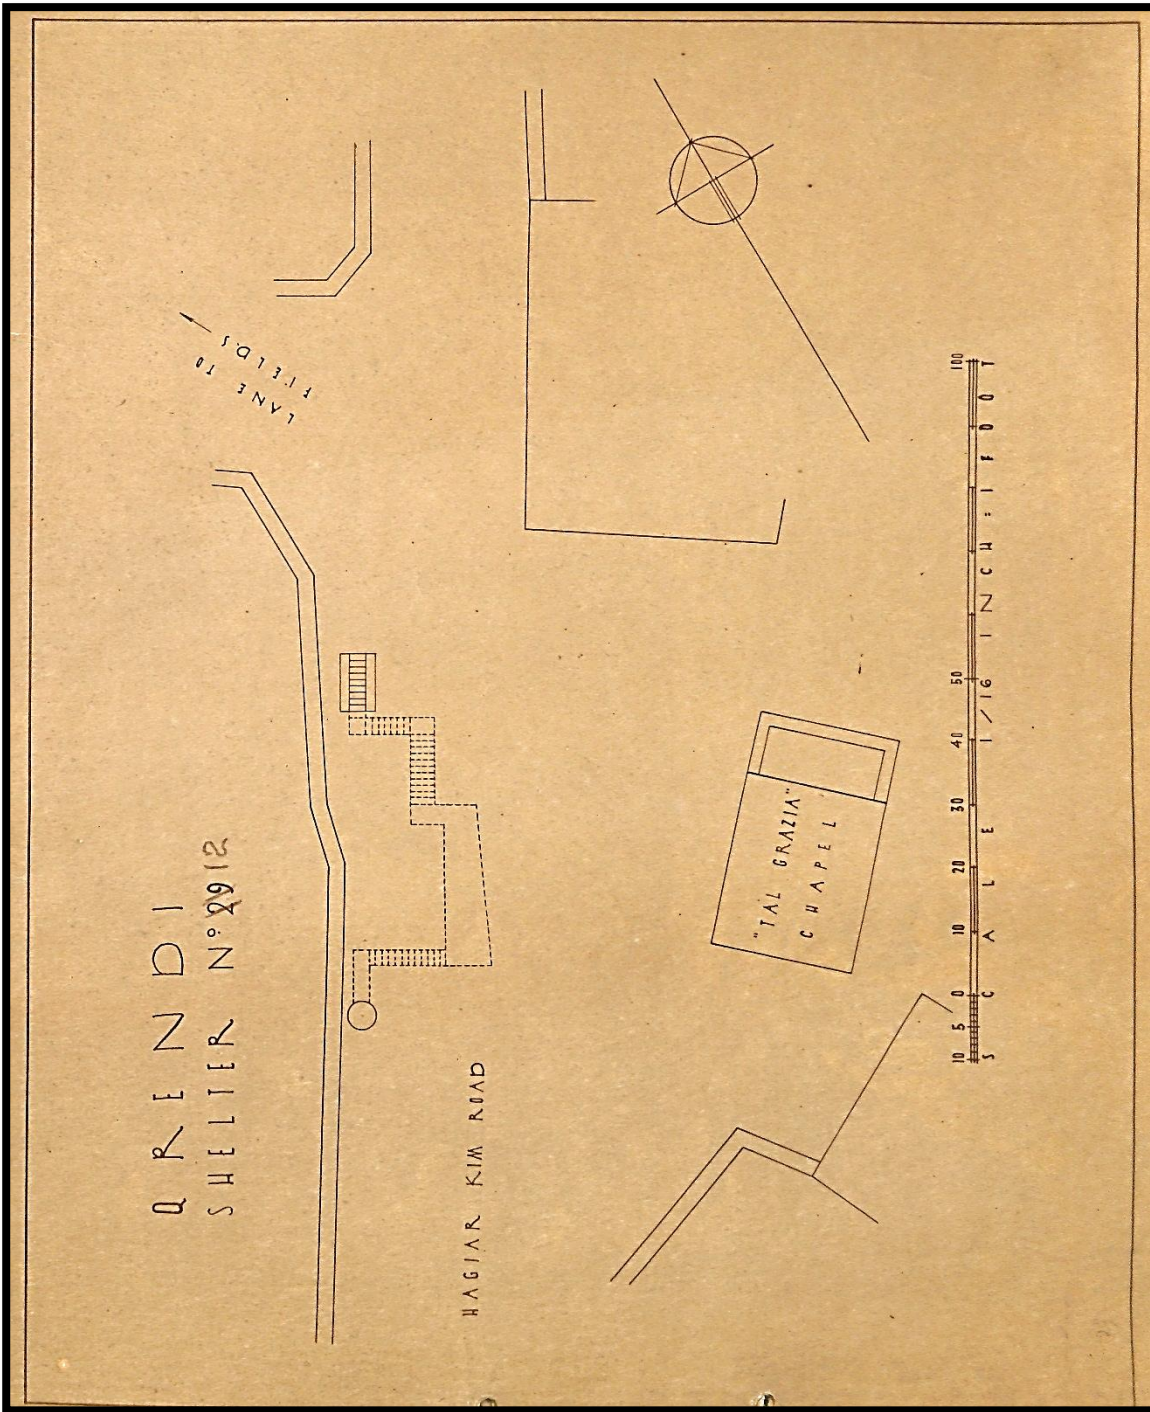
Planta do Abrigo nº12 "Hagiar Kim Road – Lane To Field's."
